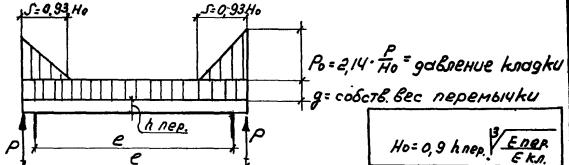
Схема нагрузок на перемычки при расчете по случаю "д".
